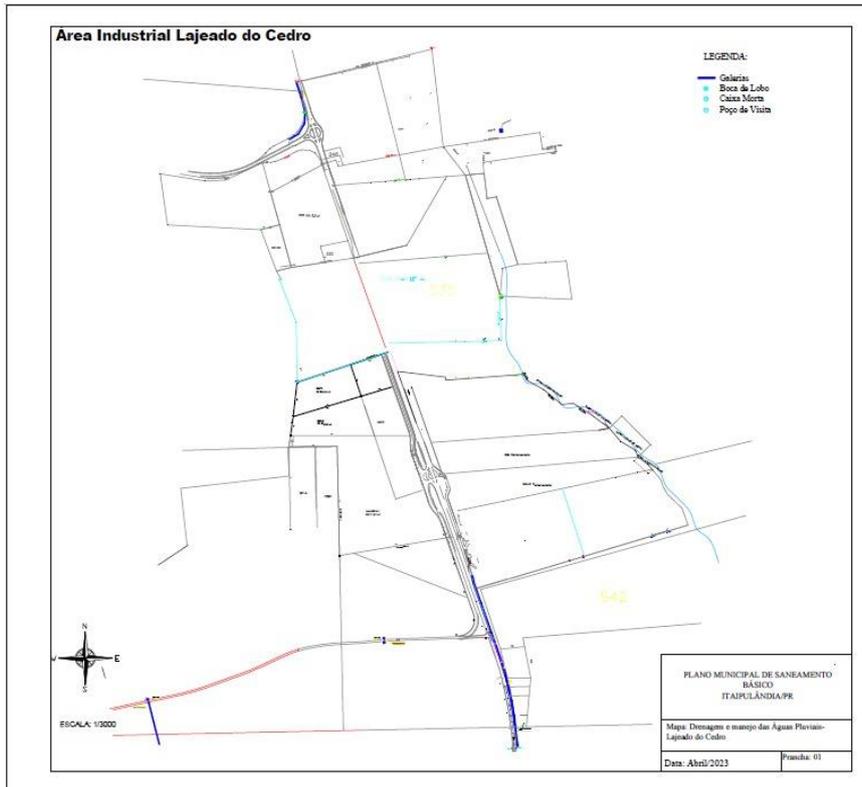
Sistema de drenagem do Lajeado do Cedro.
